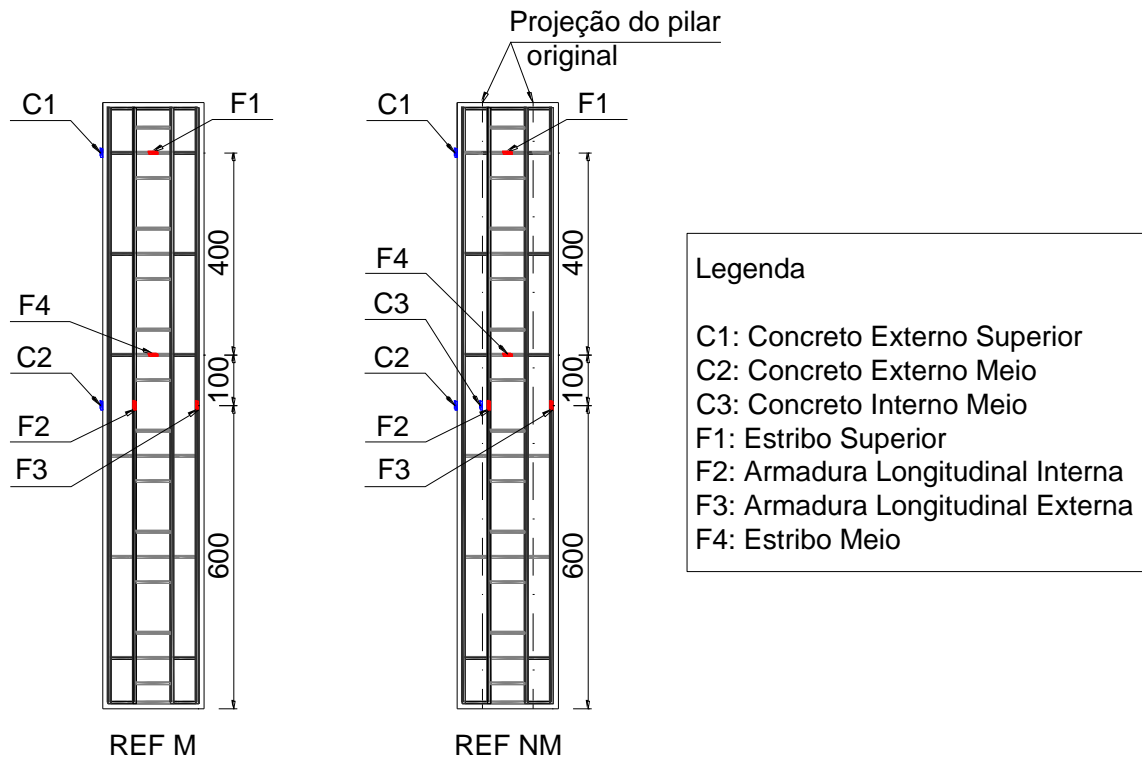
Posicionamento dos extensômetros nos pilares REF M e REF NM
